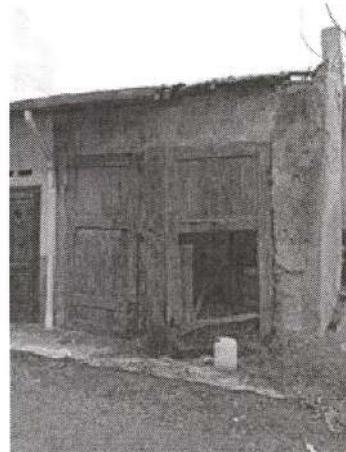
FOTO ANNESSO ANCORA ESISTENTE COLLABENTE
